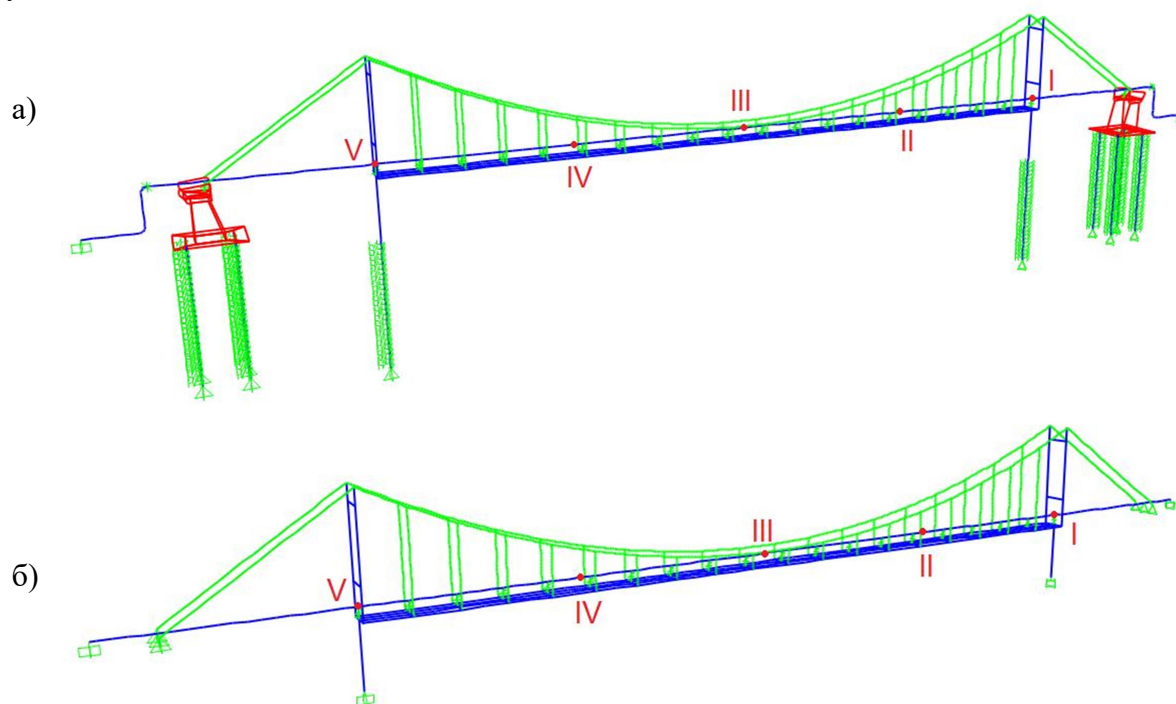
Расчетные схемы трубопроводного перехода через р. Ока в г. Орел с нумерацией расчетных сечений: а) схема 1, б) схема 4
